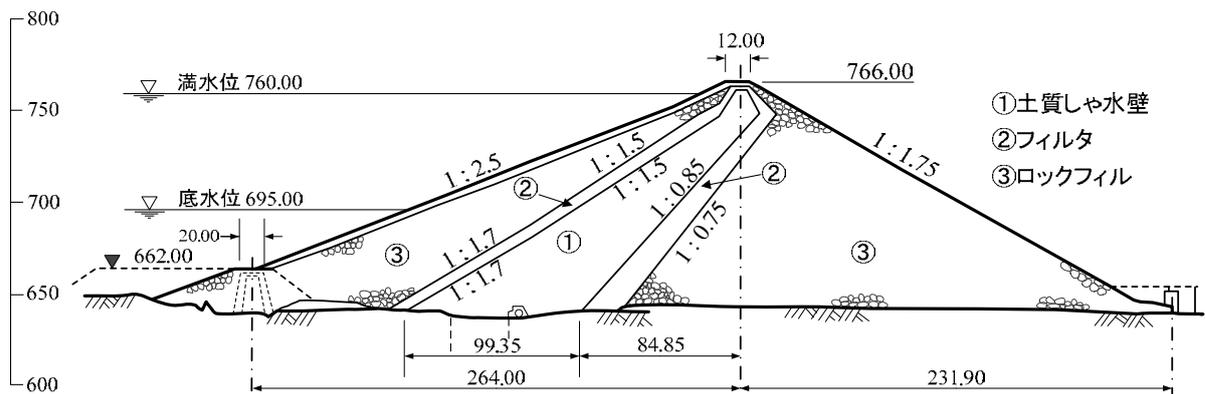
御母衣ダム堤体標準断面図³⁻¹⁰⁾
